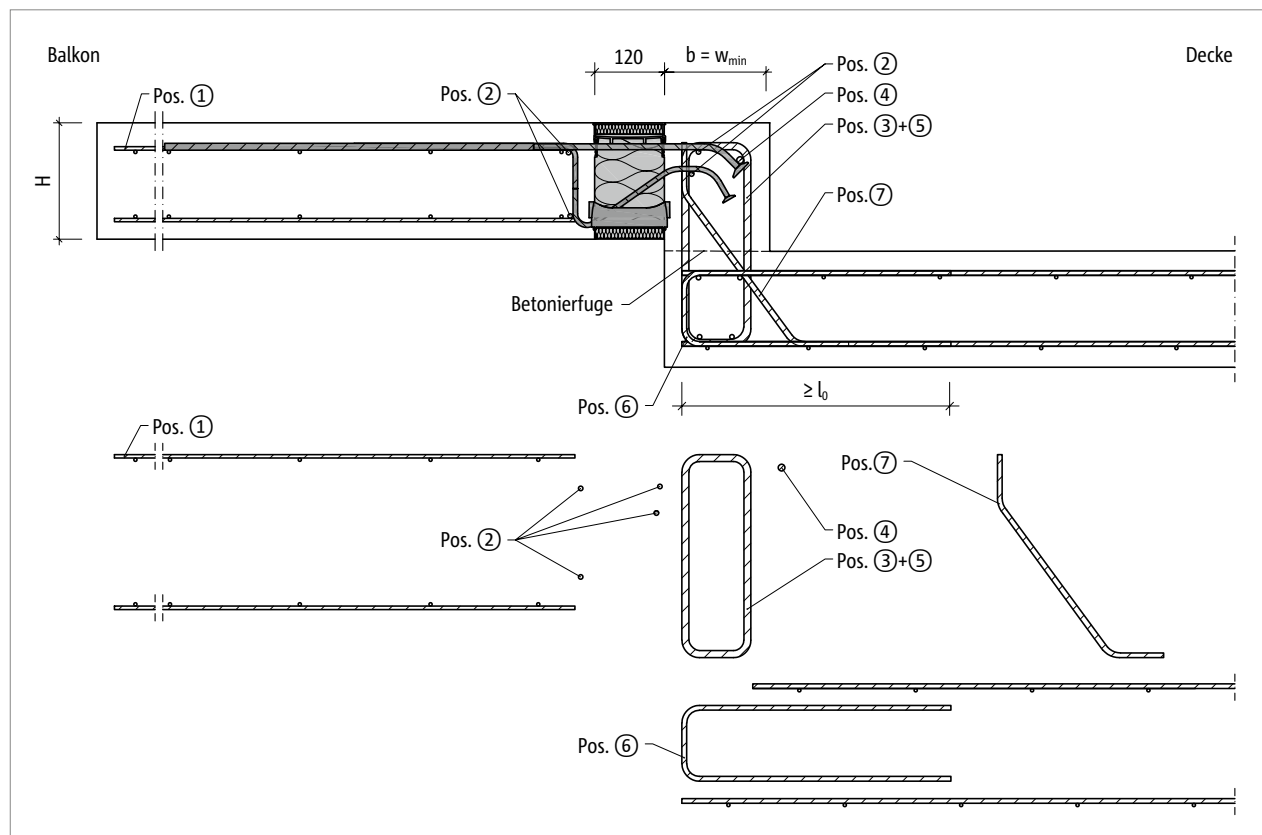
Schöck Isokorb® XT Typ KL-O: Bauseitige Bewehrung für Balkon mit Höhenversatz nach oben mit minimaler Bauteilabmessung ( $w_{\text{vorth}} = w_{\text{min}}$ )
